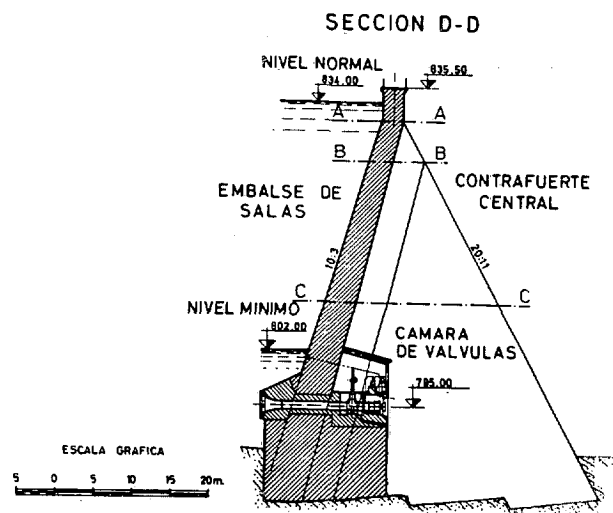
Sección del contrafuerte central en la que se aprecia la cámara de las válvulas de fondo.
